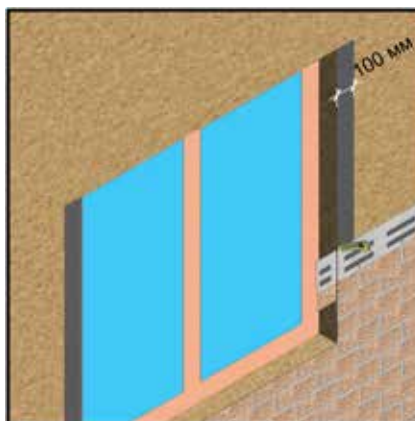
Подрезка фасадной плитки при подходе к углам оконных проёмов.
